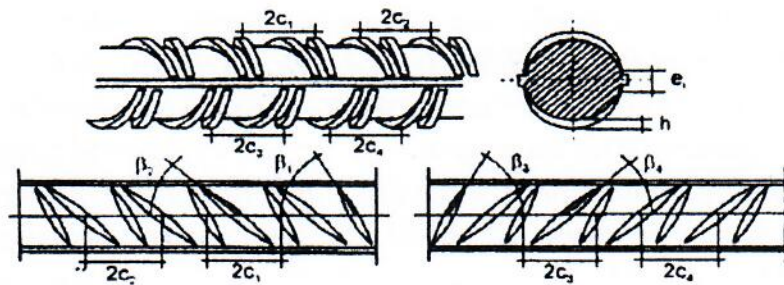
Suprafața barelor profilate din oțel pentru armarea betonului, B500SP – geometria nervurilor
